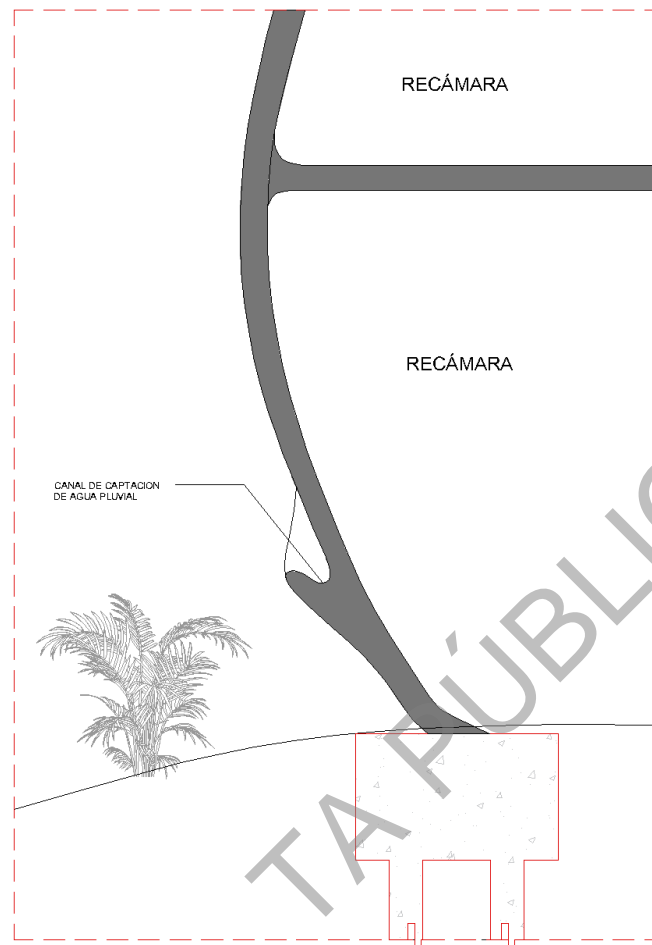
Detalle tipo, corte de canal de captación de agua pluvial.
